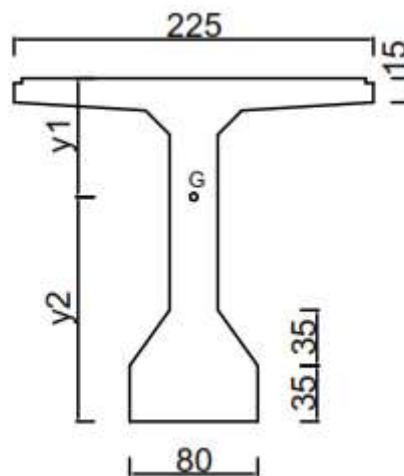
section de la poutre pour le calcul des paramètres fondamentaux
